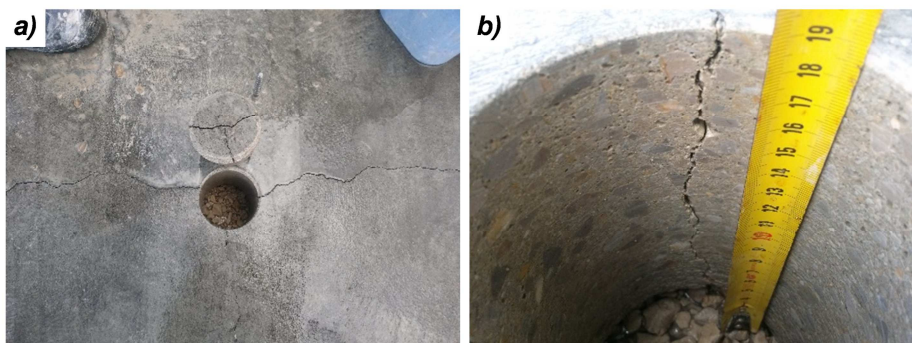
44 – 27.05.2014 - Extracción de testigo en losa de 380 m<sup>2</sup>
